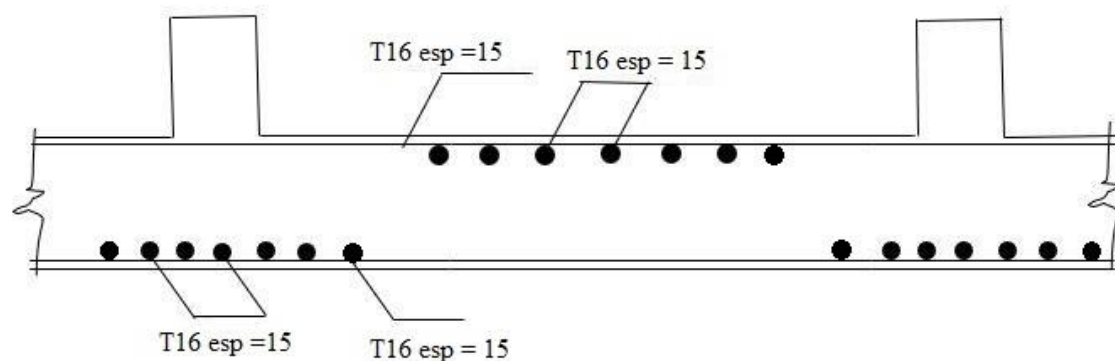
Schéma de ferrailage de la dalle du radier
